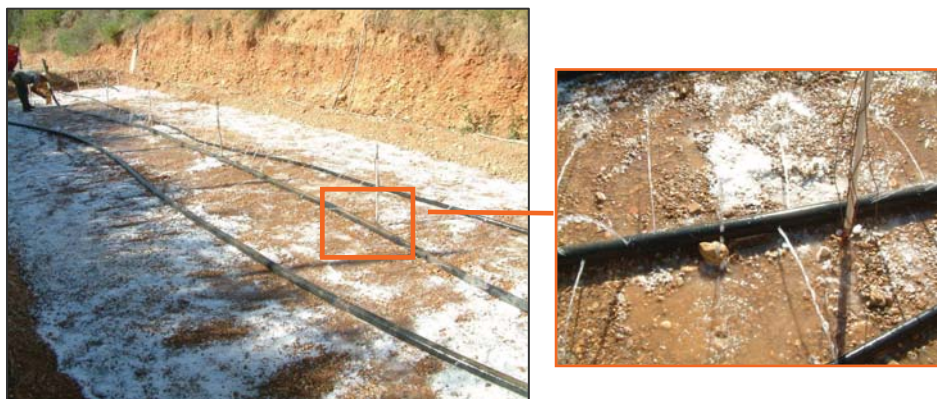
Pormenor durante o enchimento da bacia e da infiltração do traçador
